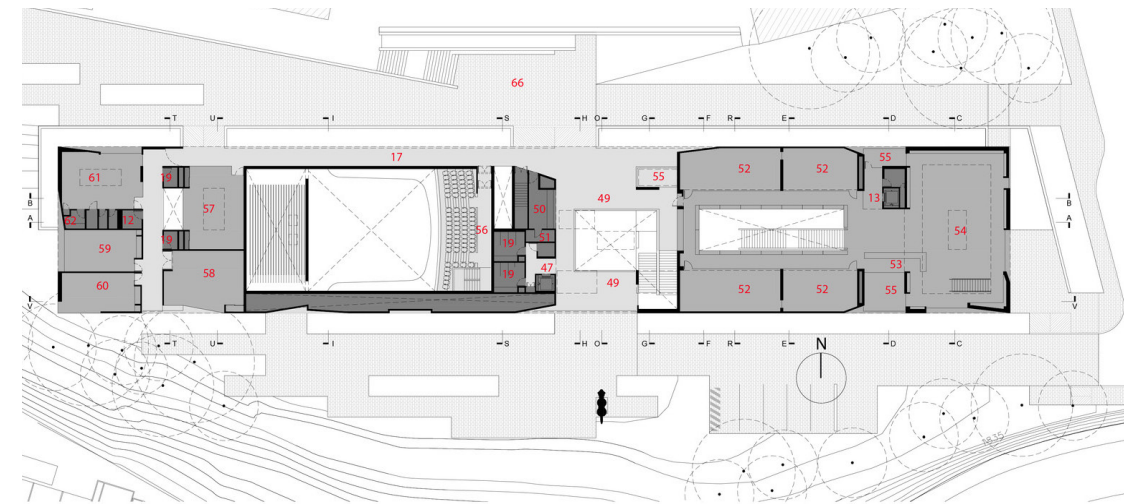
Planta del Parque Biblioteca Fernando Botero
